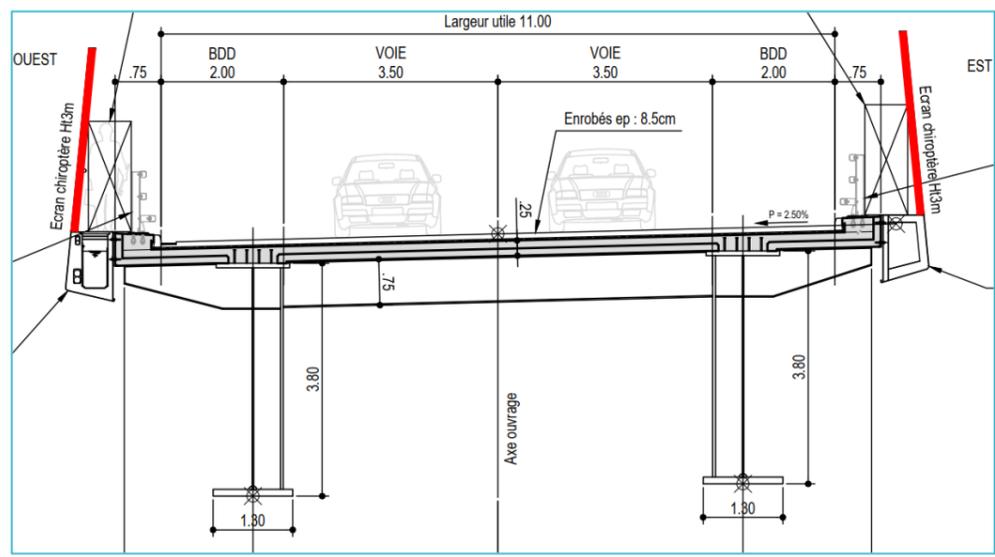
Profil en travers au droit du viaduc de l'Yonne (source : Setec 2023)
